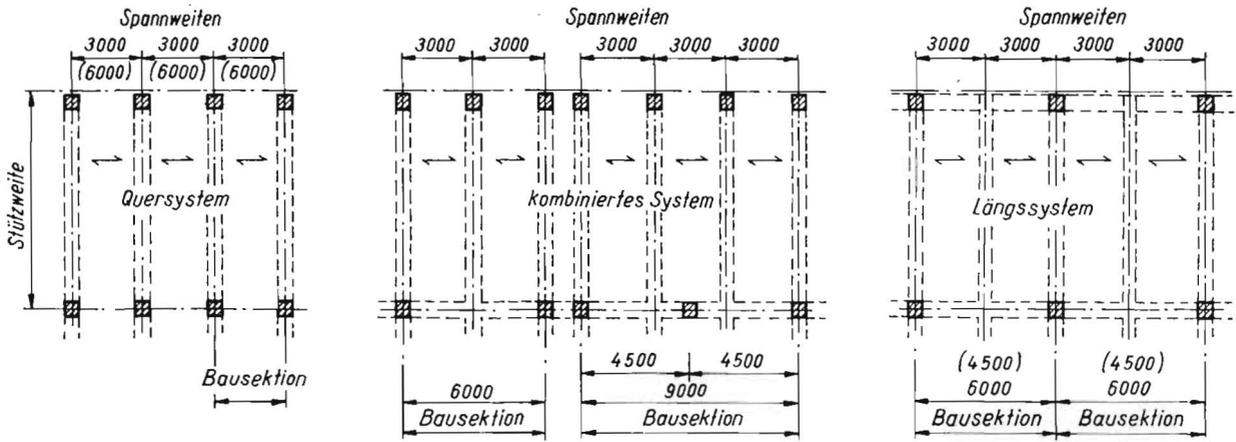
Konstruktionssysteme der Stahlbetonskelett-Montagebauweise (in Gebäudelängsrichtung)
